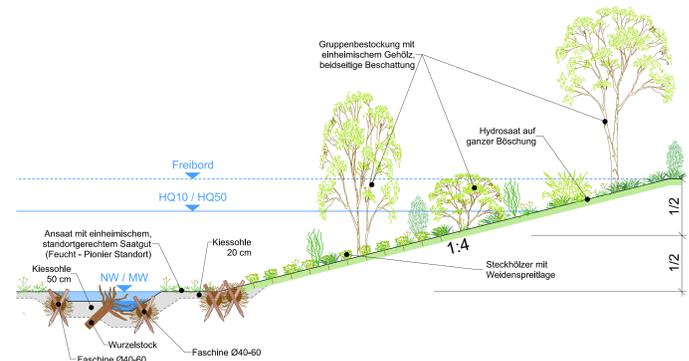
Normalprofil mit Böschung 1:4 mit Ufersicherung aus Variante 2
